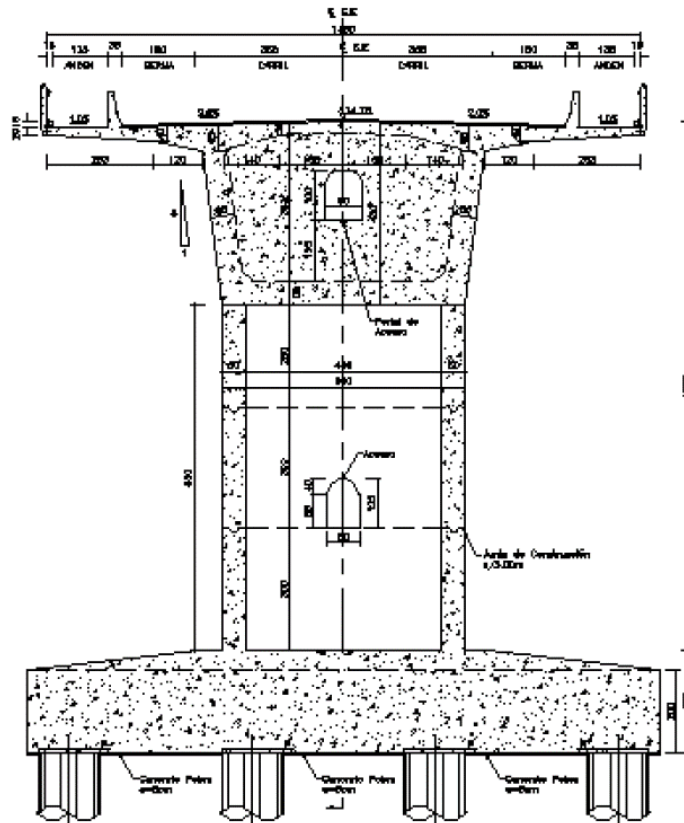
Geometría del apoyo eje 4 y 5 puente San Pedro.
